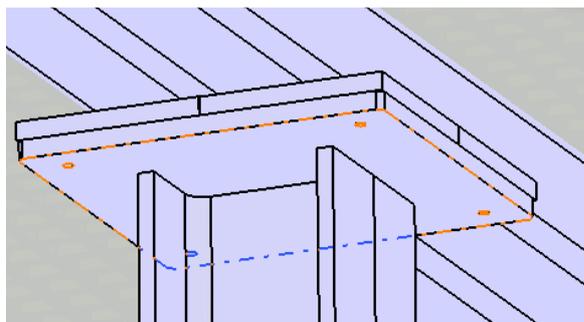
Ensamblaje de la plataforma atornillada sin tener que disponer de bulones.
